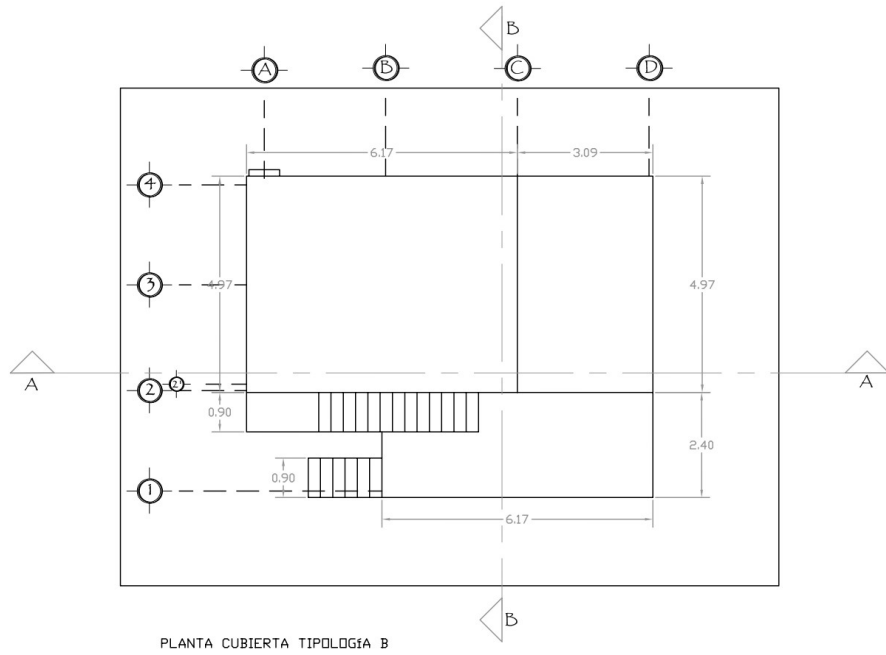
Planta Cubierta Tipología - B - Elaboración propia
